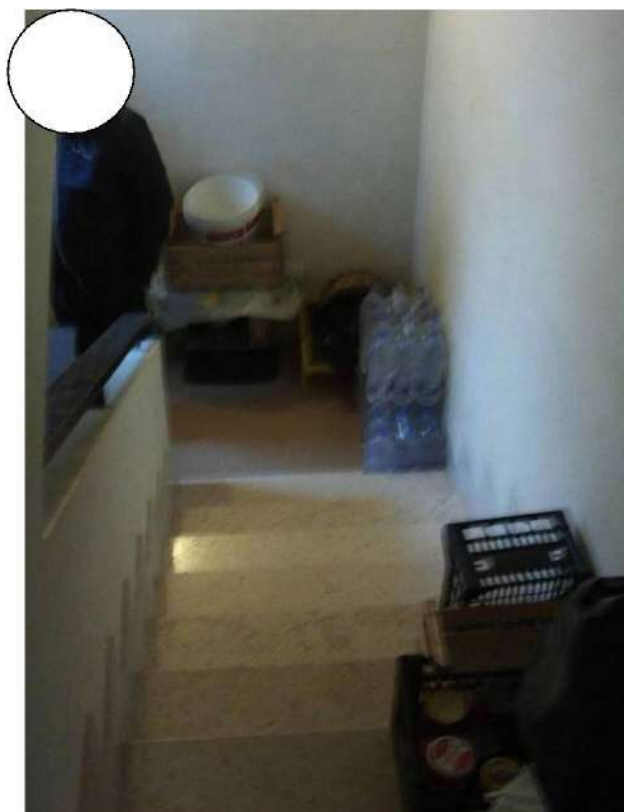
Foto interno : porta e rampa scala – sub 4 piano T
